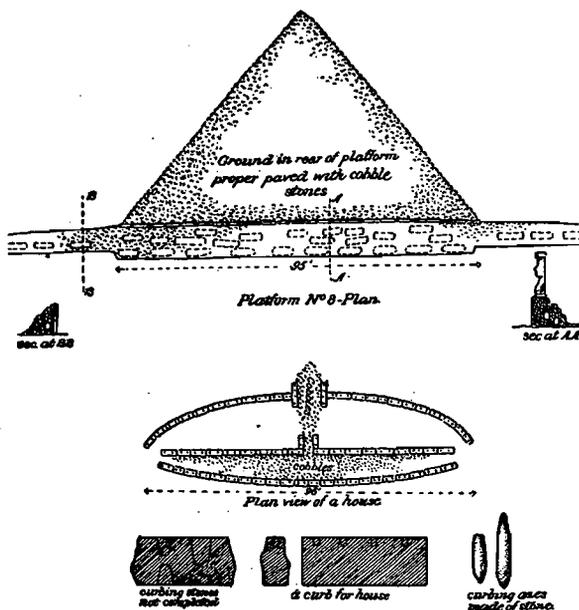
Vista del plan general de construcción de la plataforma. También el plano de la construcción de una casa con detalles.
